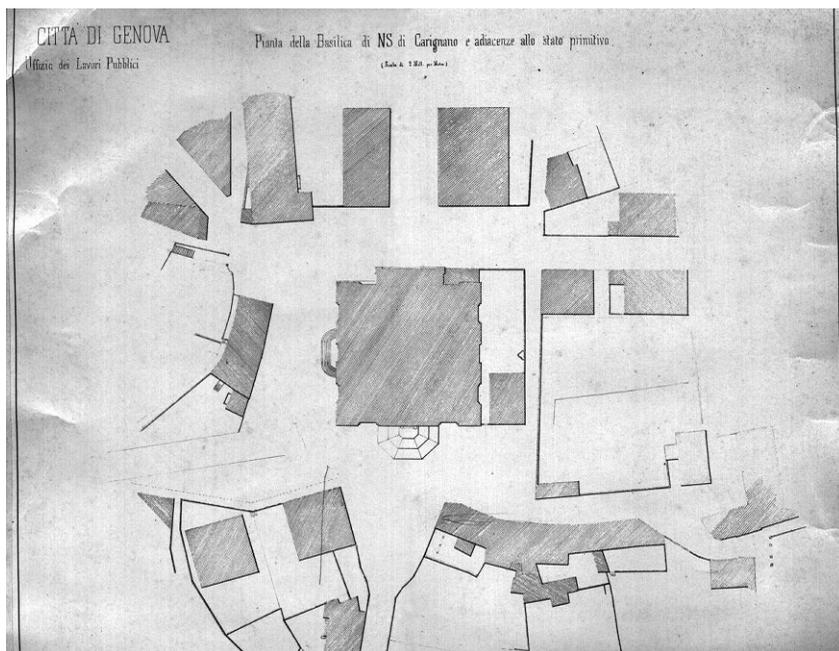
Planimetria della zona circostante la basilica di Carignano anteriormente al 1870, A.D.G., A.S.
